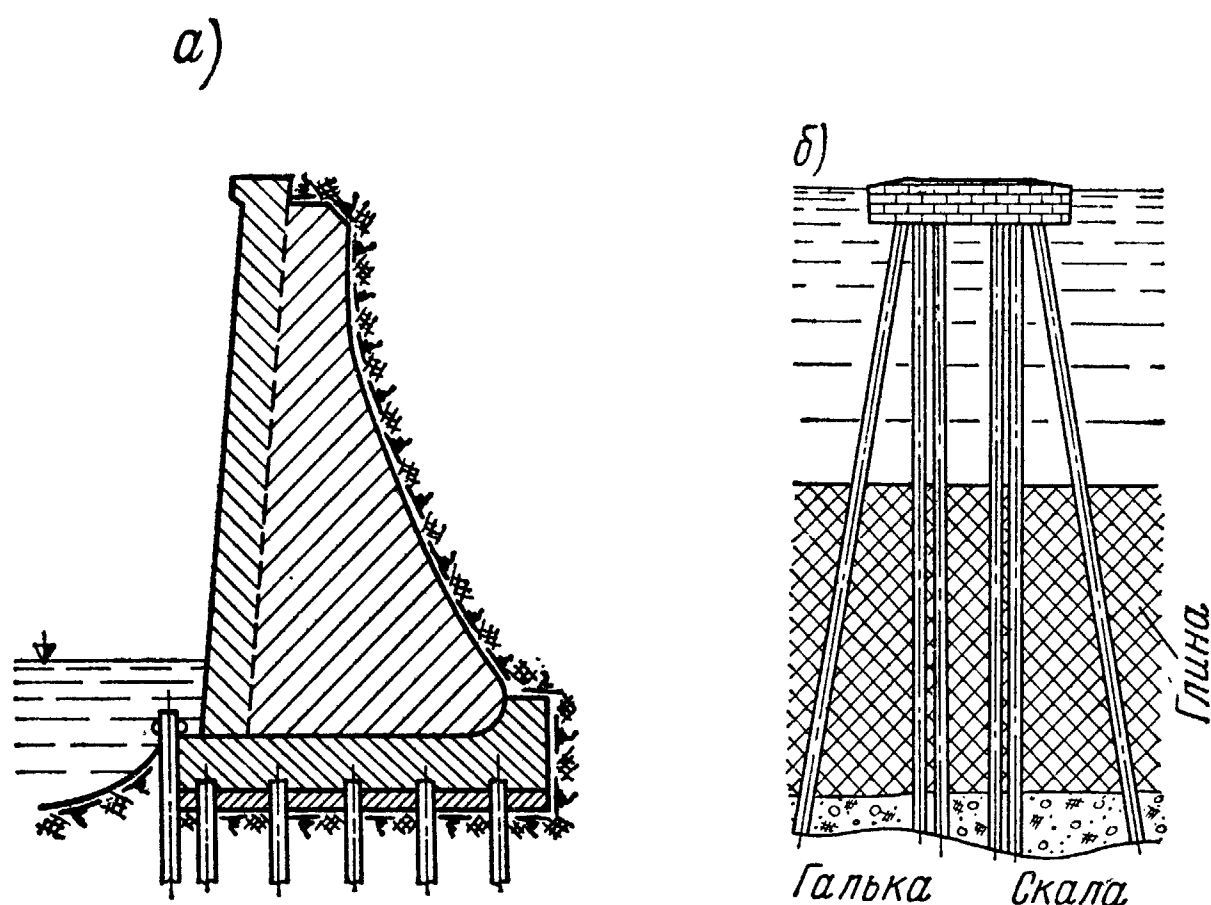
Виды свайных фундаментов по конструкции ростверка:
